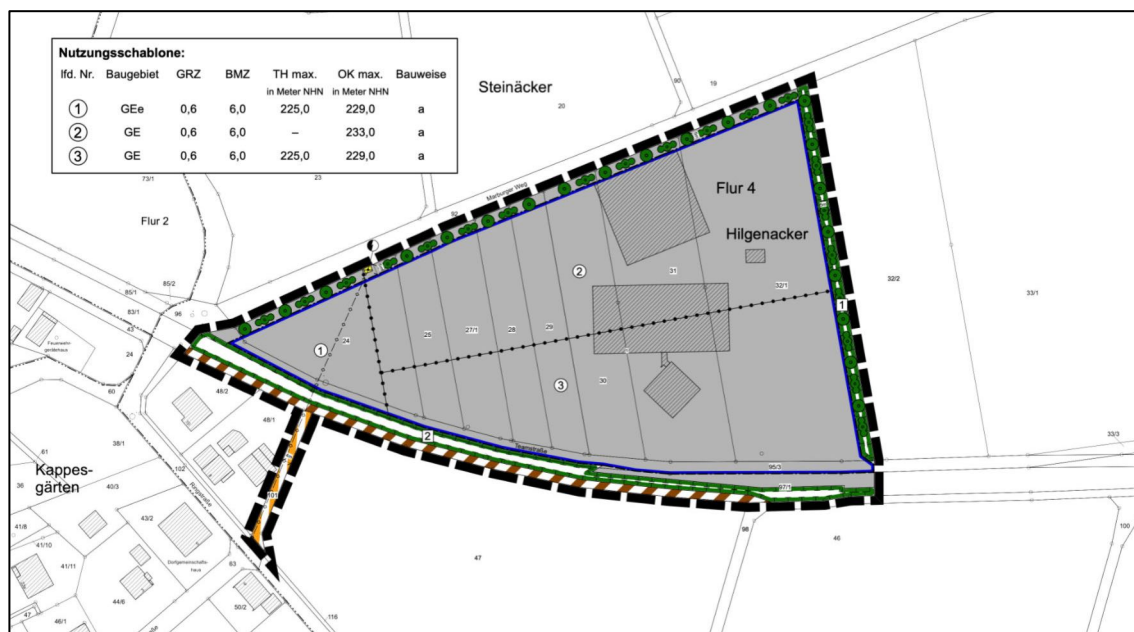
Bebauungsplanvorentwurf - Planteil
